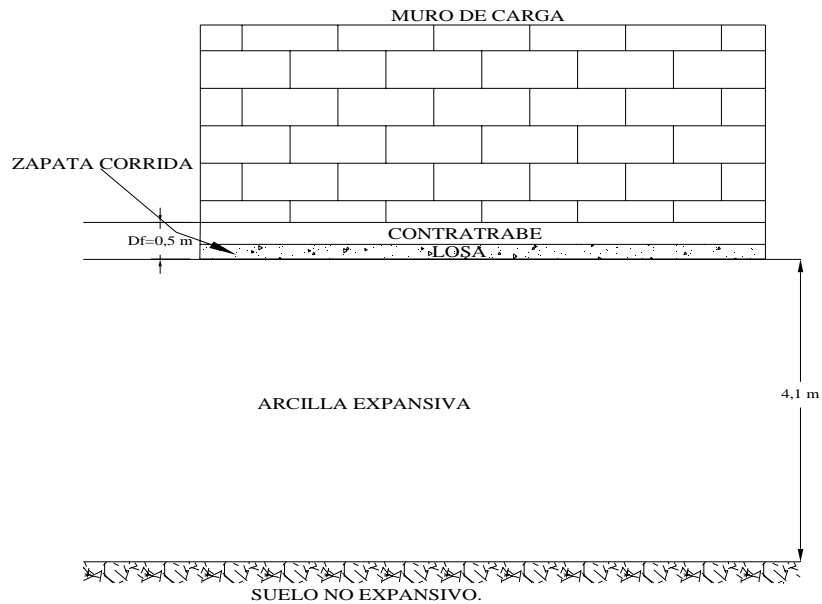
Muro de carga y zapata corrida sobre arcilla expansiva.
